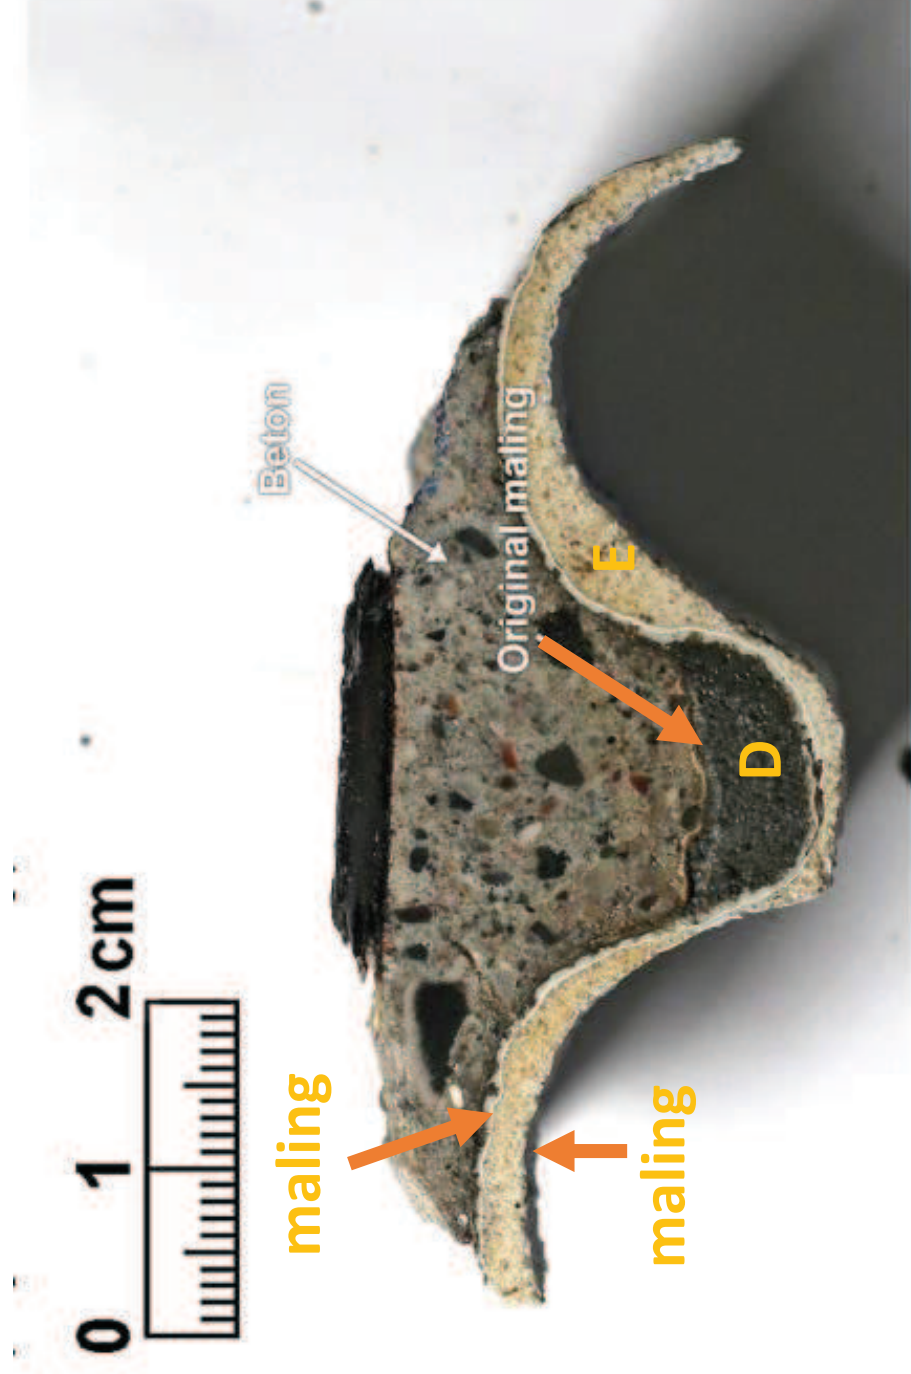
Betonstykke P38: På fotoet ses et tværsnit gennem betonstykket på foto 18 med altanpladens riflede underside nederst. I betonstykket optræder en grå, finkornet mørtel (type D) som er påført udenpå altanpladens riflede underside med beton og original maling. Den grå reparationsmørtel er påført flere lag hvidgrå maling efterfulgt af et tyndt lag hvid, finkornet mørtel (type E).
